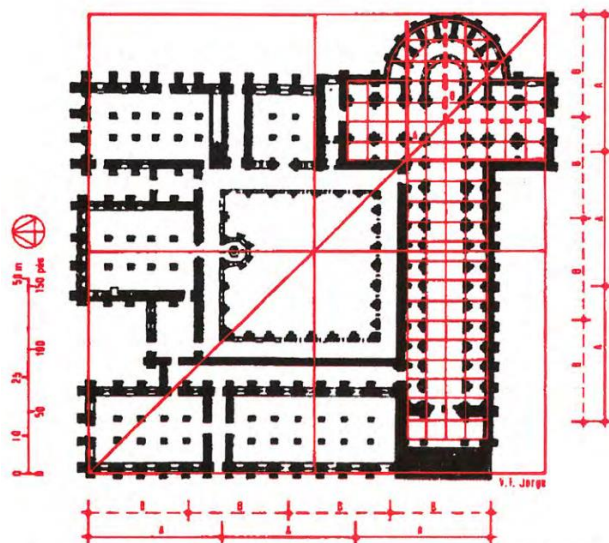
Planta medieval (reconstituição) da Abadia de Alcobaça, no traçado modular.
